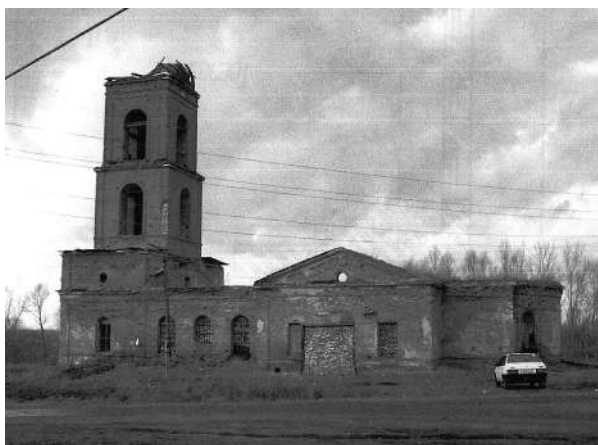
Вид южного фасада и покрытия храма по состоянию на 2005 год
